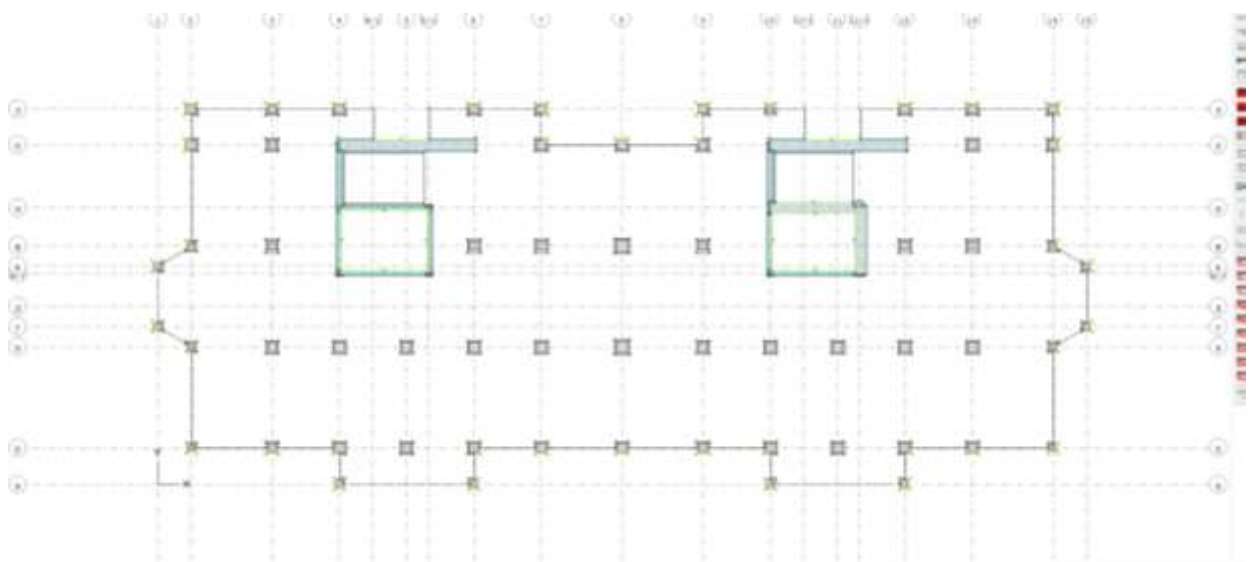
Плита перекриття Пм -1. Опалубкове креслення
